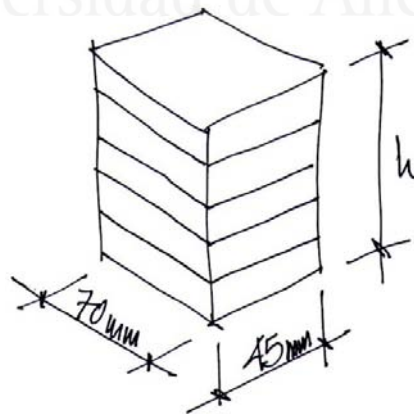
Dimensiones de la probeta para ensayo compresión en el espesor
